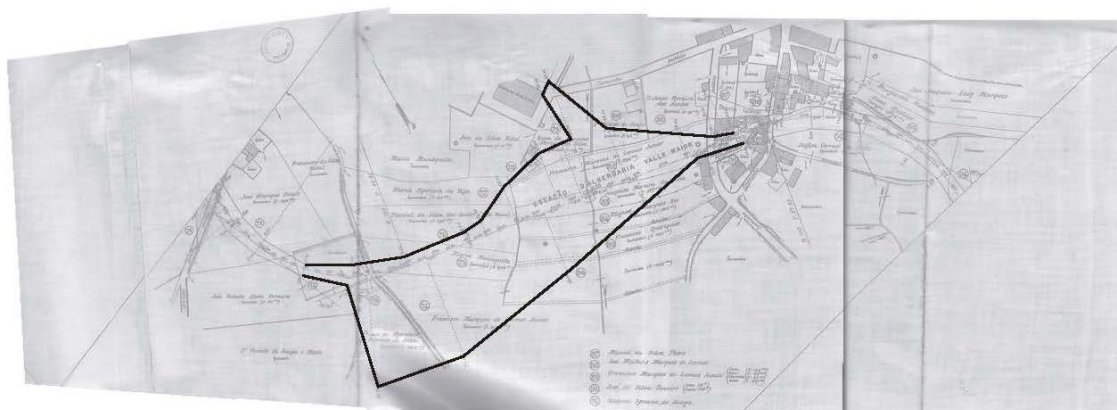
Planta de Pormenor do traçado da linha e implantação da estação em Albergaria-a-Velha. 1908.
